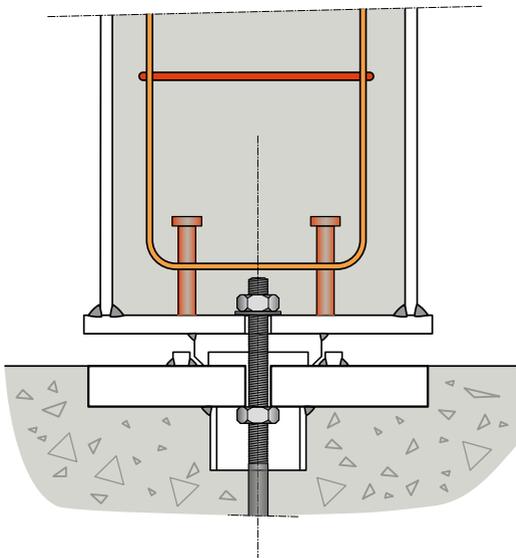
Pied de poteau mixte – Profilé partiellement enrobé – Platine à grain
